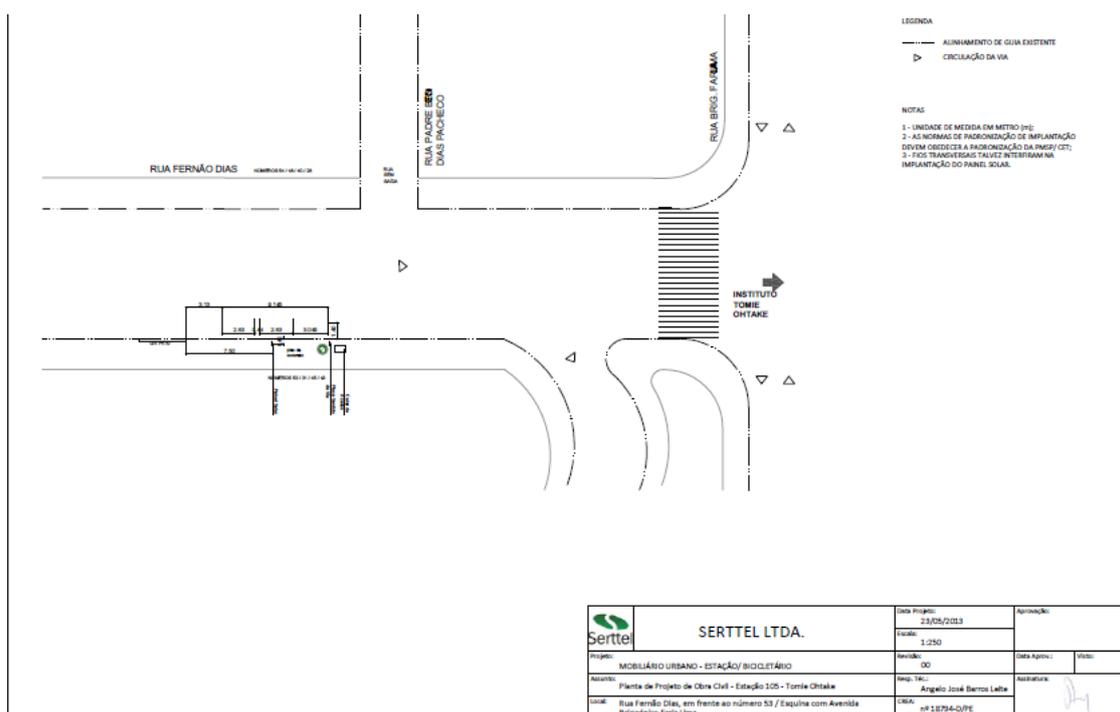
Figura: Exemplo de planta de obra com a localização dos chumbadores da Estação.
